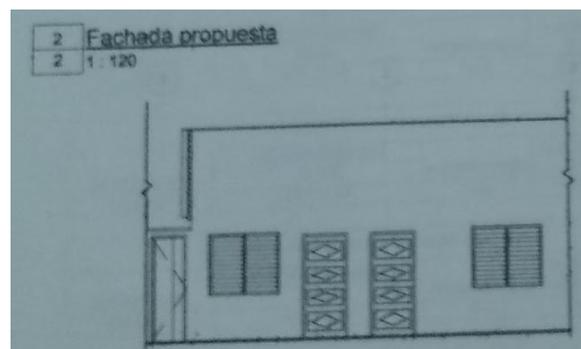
Fachada propuesta de la vivienda de Tipología III. Fuente: Foto tomada por la autora al informe del proyecto facilitado en Planificación Física.
